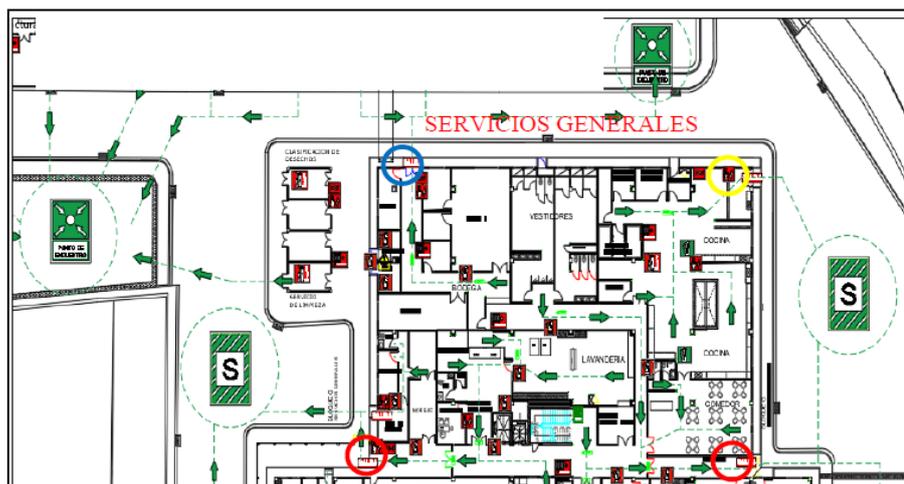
Planos de Evacuación - Planta Baja – Servicios Generales
